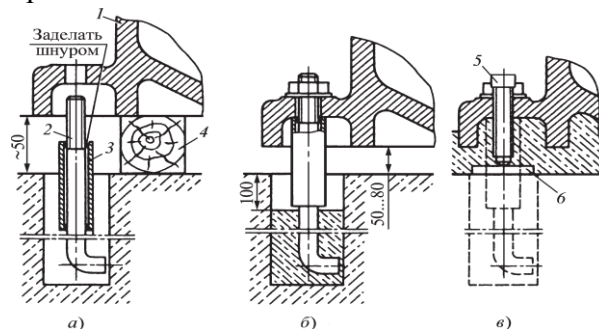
Схемы установки изогнутых болтов: а — в колодце; б — подвеска на гайке и заливка бетонной смесью; в — выверка и закрепление оборудования затяжкой гаек
